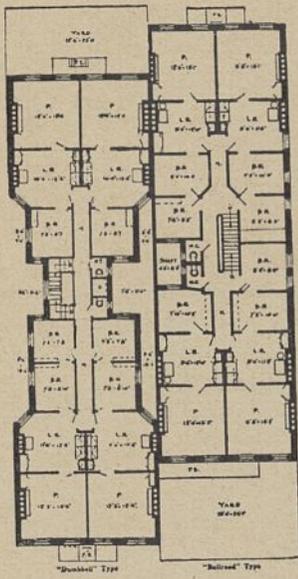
New York, Grundriß eines Miethauses mit Alkovenräumen.
